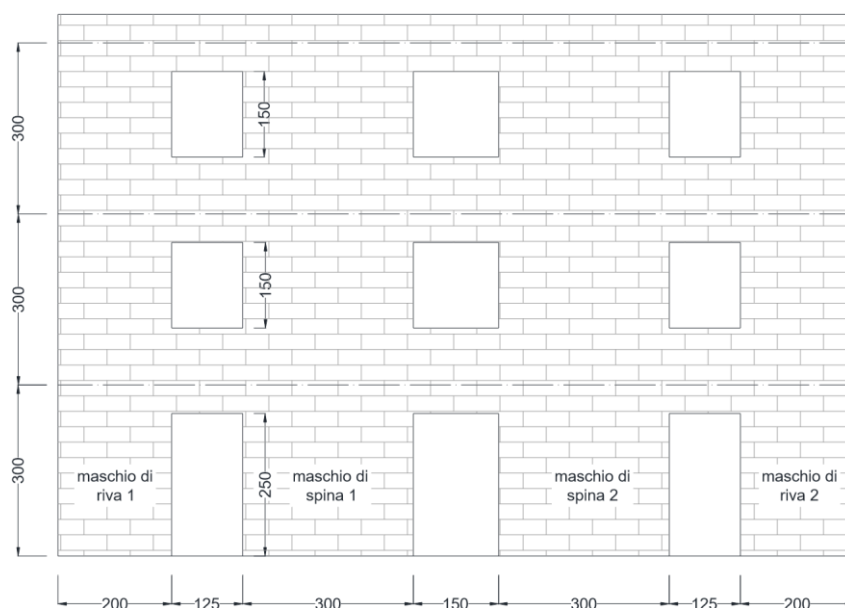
Geometria della parete oggetto di studio (dimensioni in cm).
